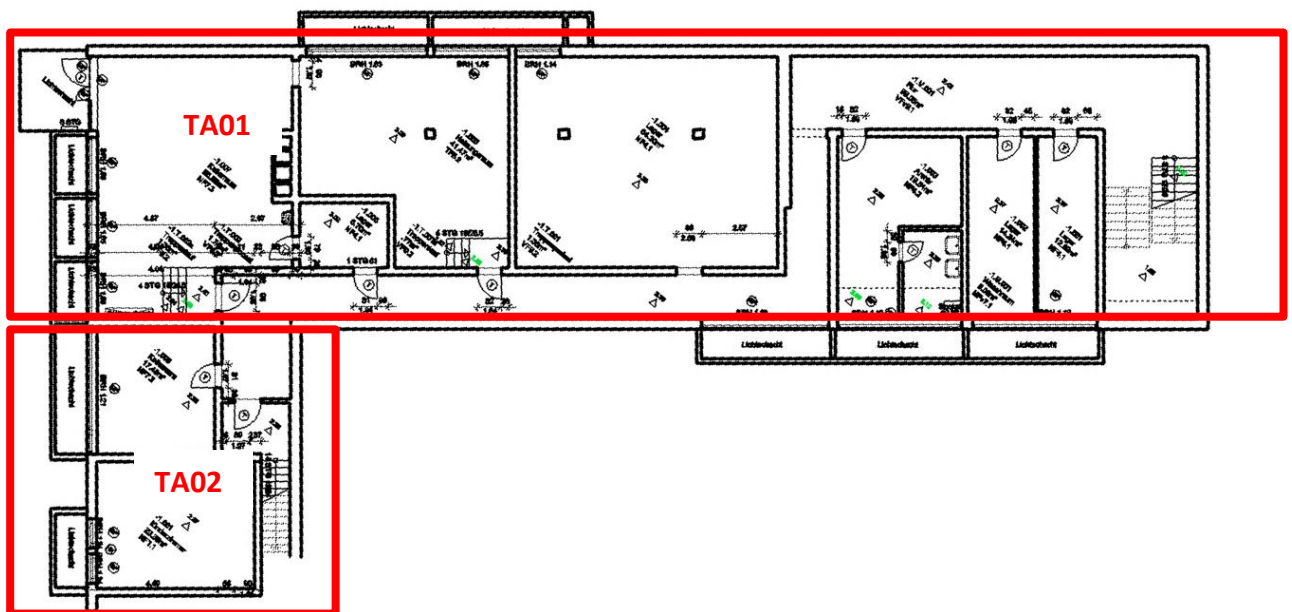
Ausschnitt KG Grundriss Schulgebäude Trakt A
